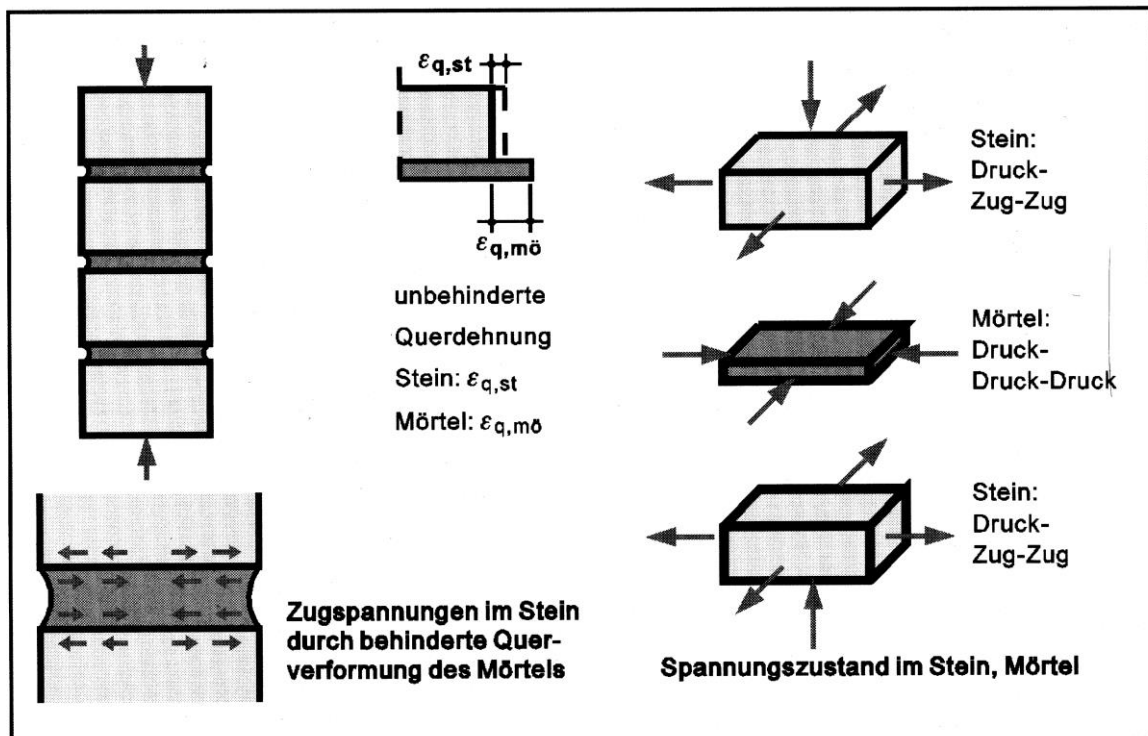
Mauerwerk unter Druckbeanspruchung [20]
